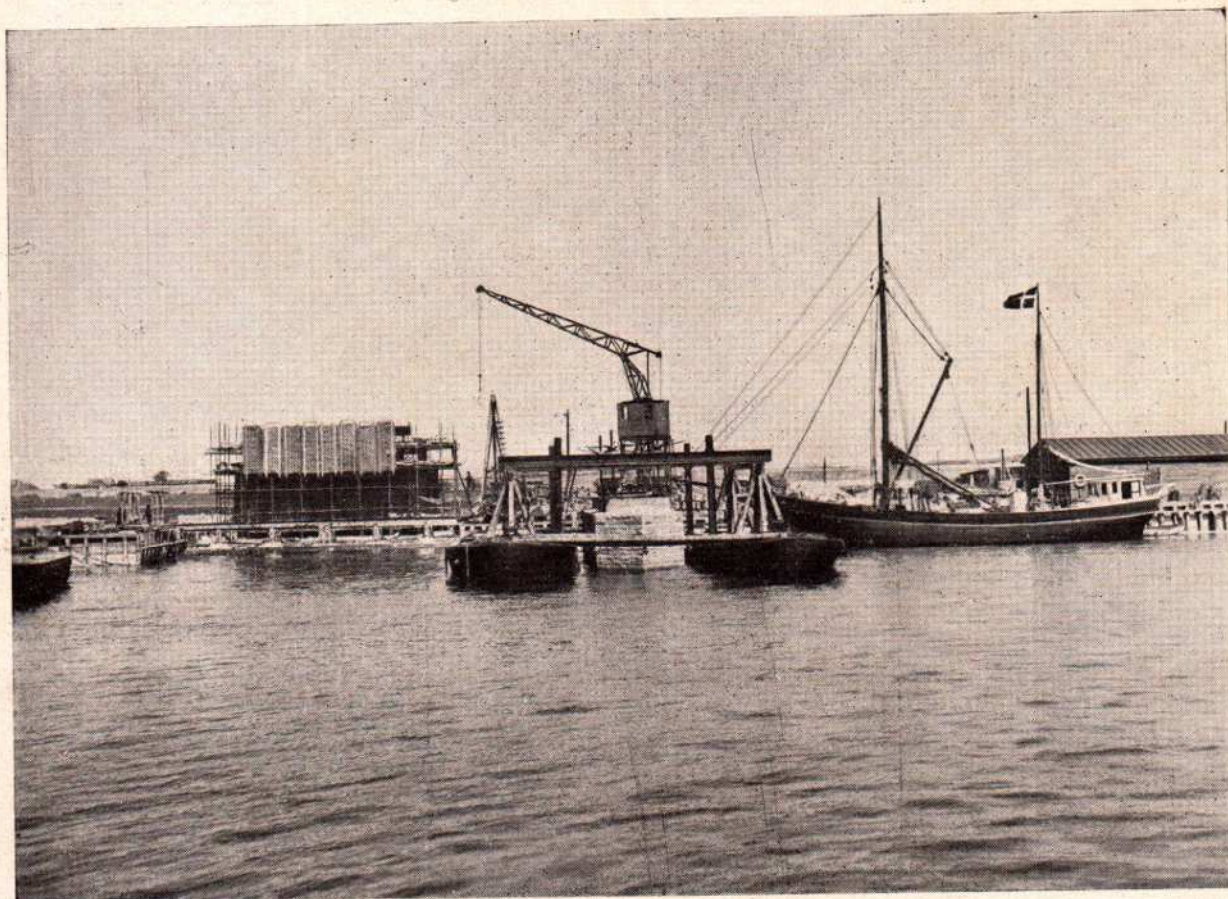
A parte do pilar revestida de granito suspensa entre dois pontões, prestes a ser posta em flutuação. No fundo á esquerda vê-se a carreira com uma outra parte de pilar em construção
